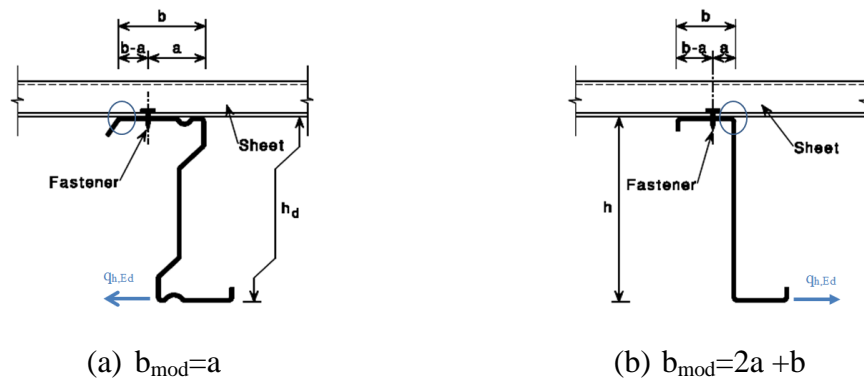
Conexão madre à chapa perfilada (adaptado de (CEN, 2006a)).
